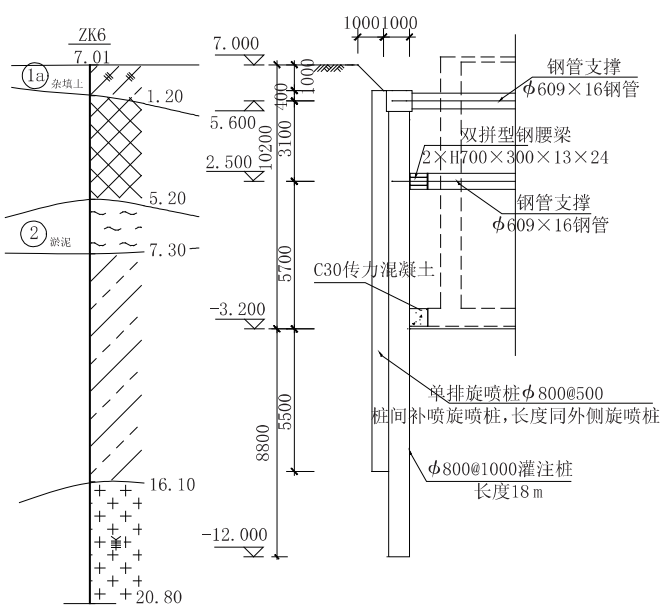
基坑剖面布置图(标高单位:m,其余单位:mm)
